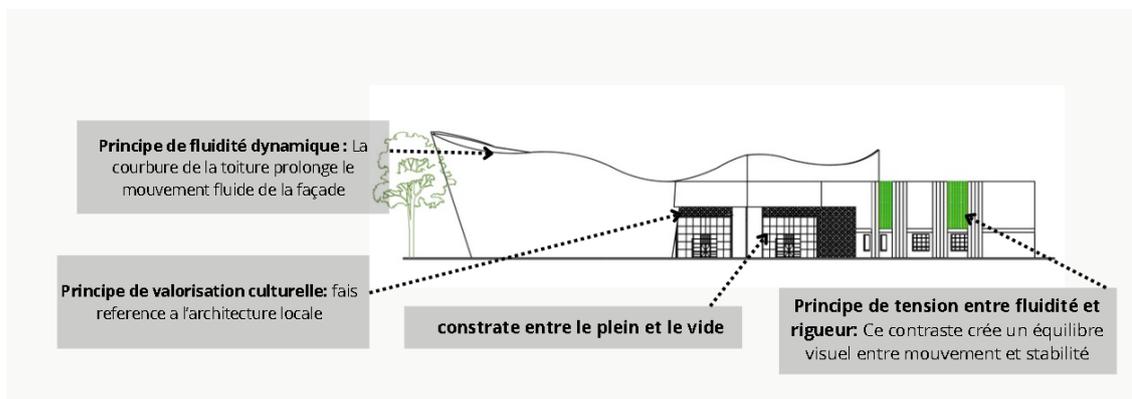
Les principes de composition des façades- Façade principale. Source : Auteurs 2025
